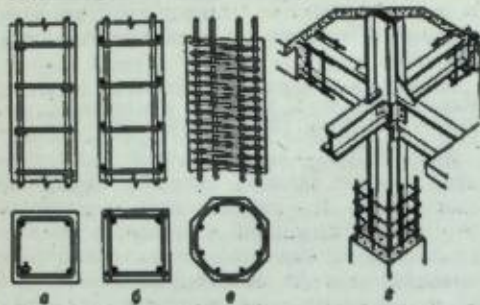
Конструкции железобетонных колонн: а — с продольной арматурой и хомутами; б — с продольной арматурой и поперечными стержнями; в — со спиральной арматурой; г — с жесткой арматурой (пример).
